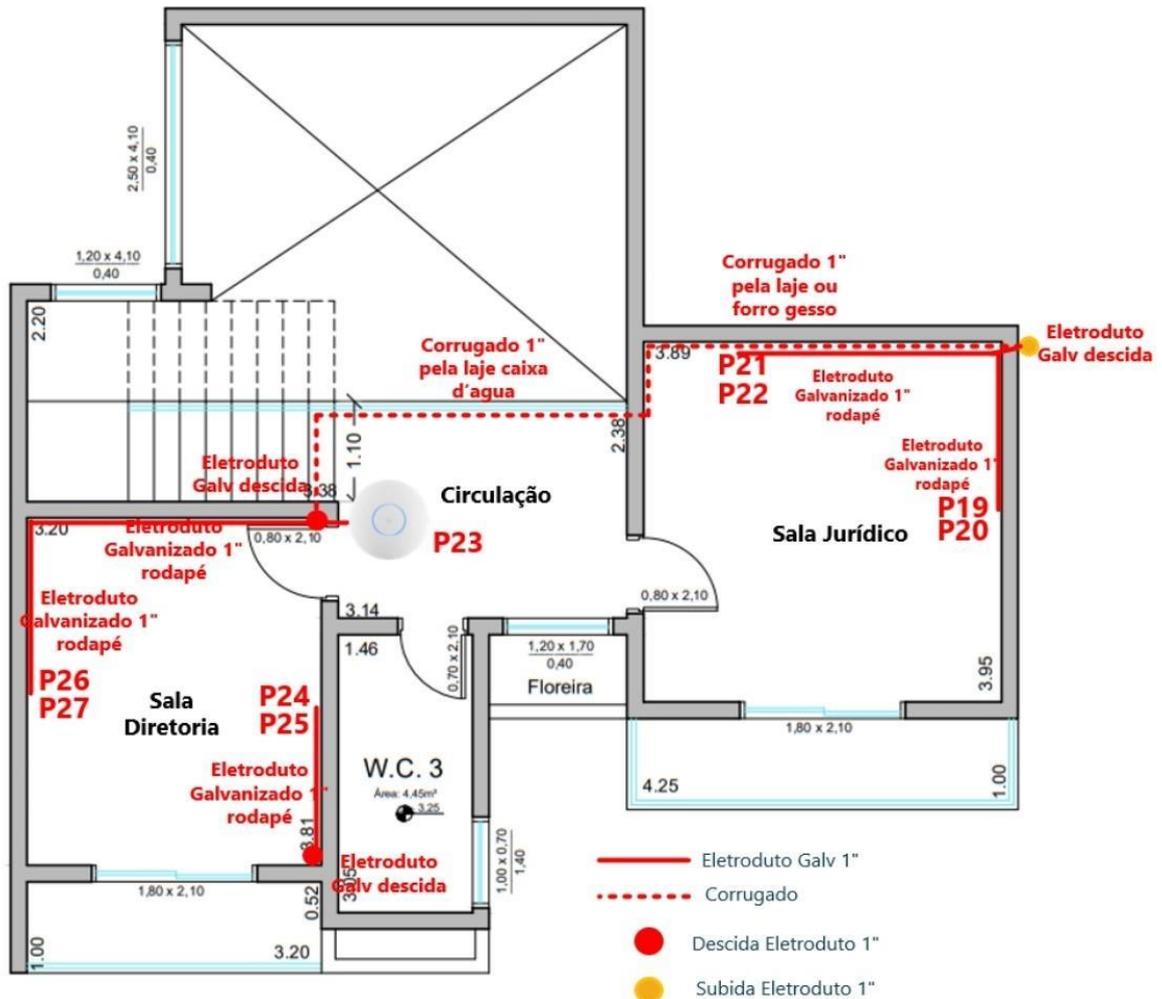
Planta piso superior com indicação dos pontos de rede
